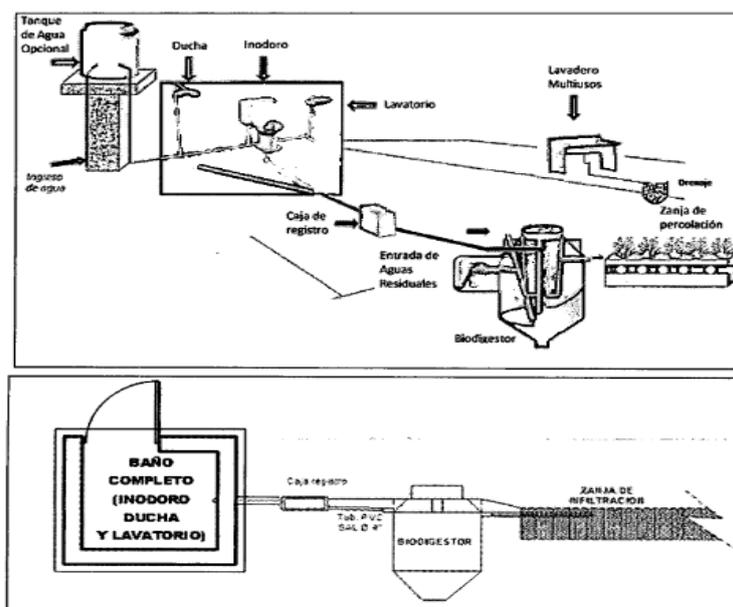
UBS-AH Vista en corte y planta UBS con Biodigestor
